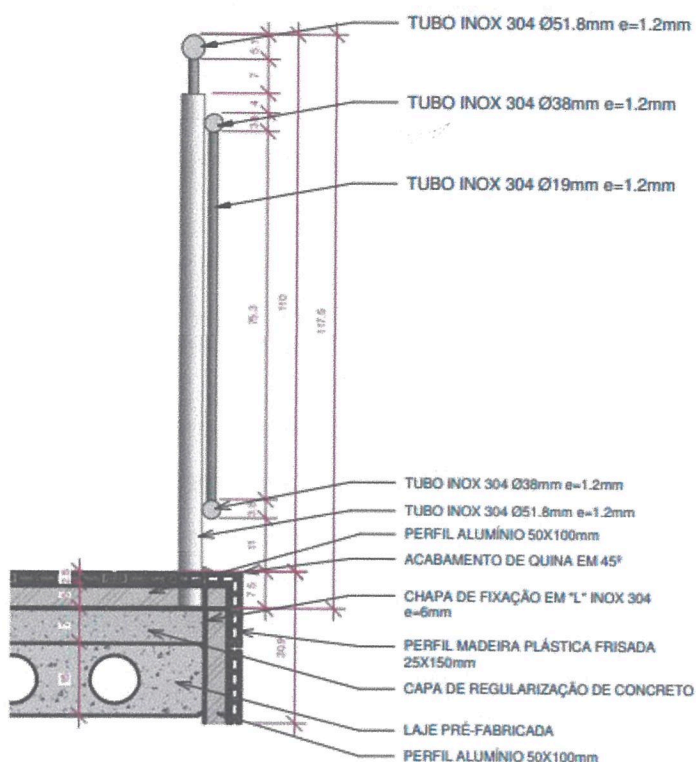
Detalhes do Guarda-Corpo - Corte.
